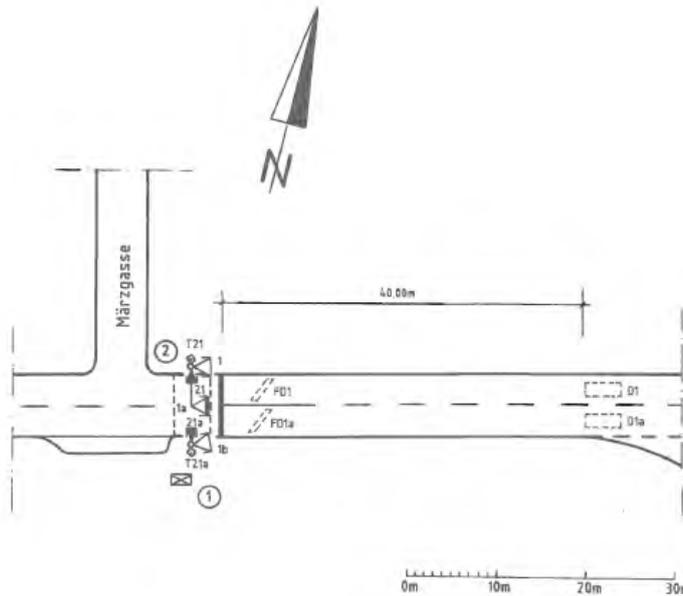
Lageplan des KP Friedrich-Ebert-Anlage / Märzgasse (K 259)
